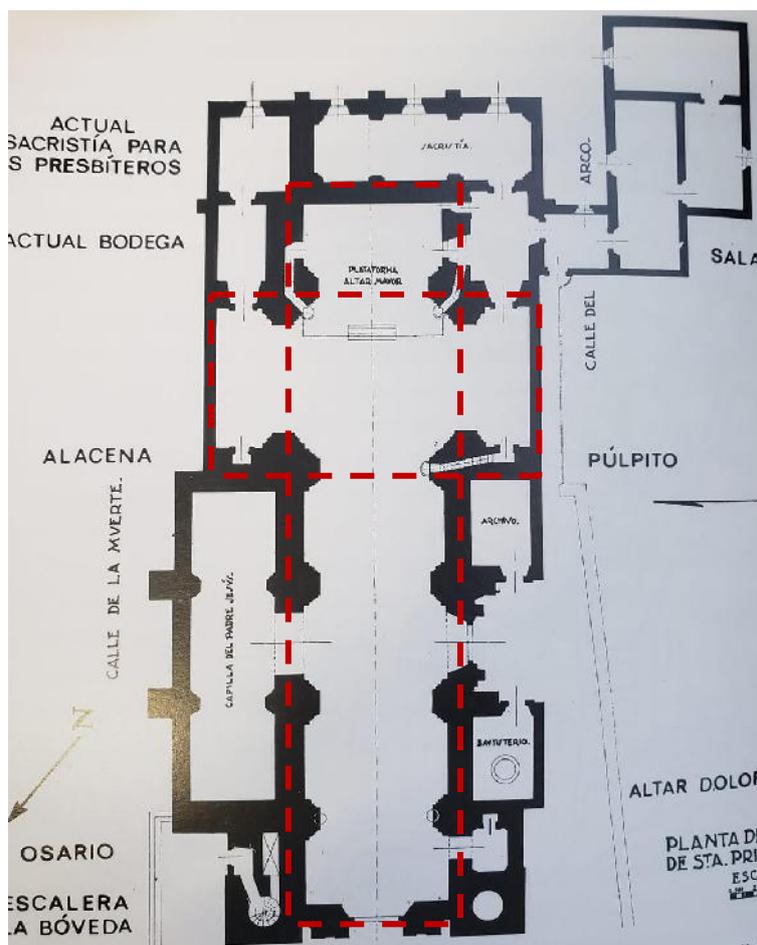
Planta de la parroquia de Santa Prisca.
